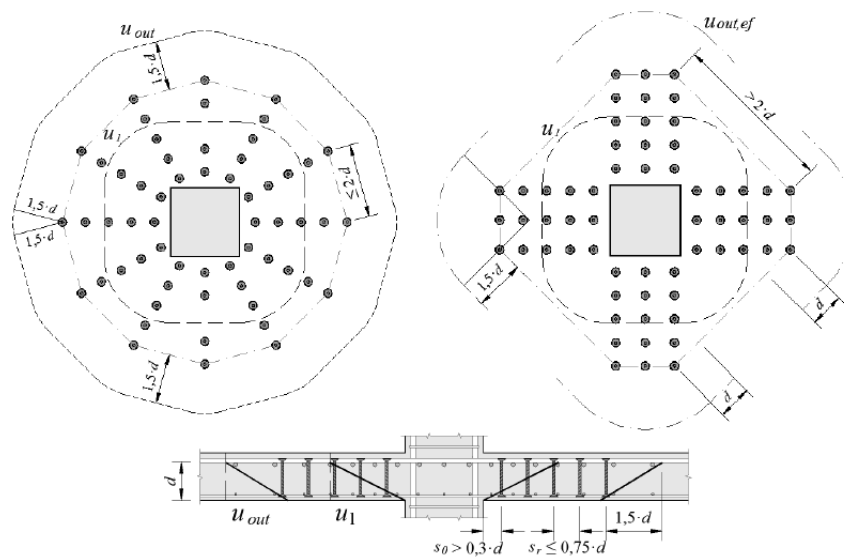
Detalhes para distribuição da armadura de cisalhamento (EC 2:2004)
